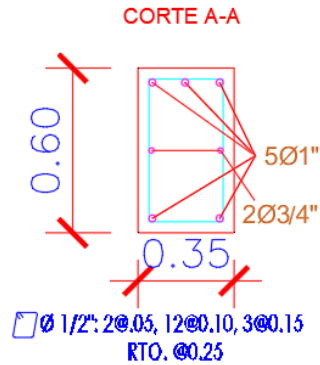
Secciones de Viga con Refuerzo 8° Piso
